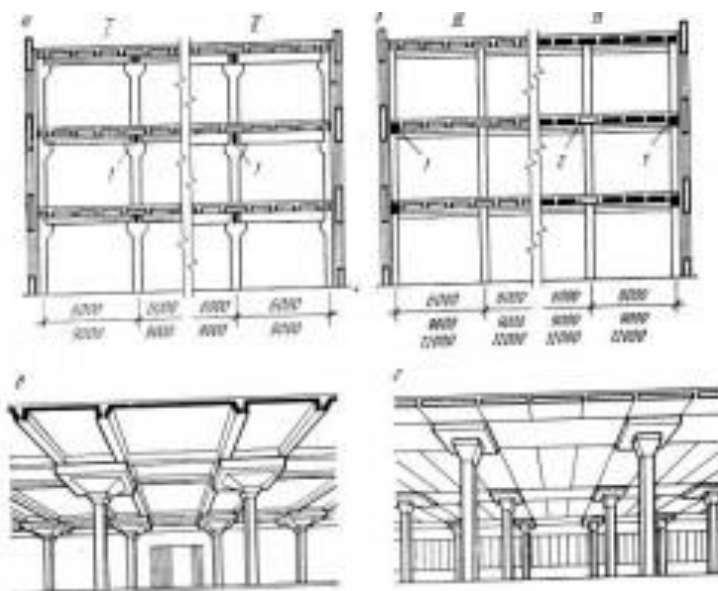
Каркасы многоэтажных промышленных зданий:
